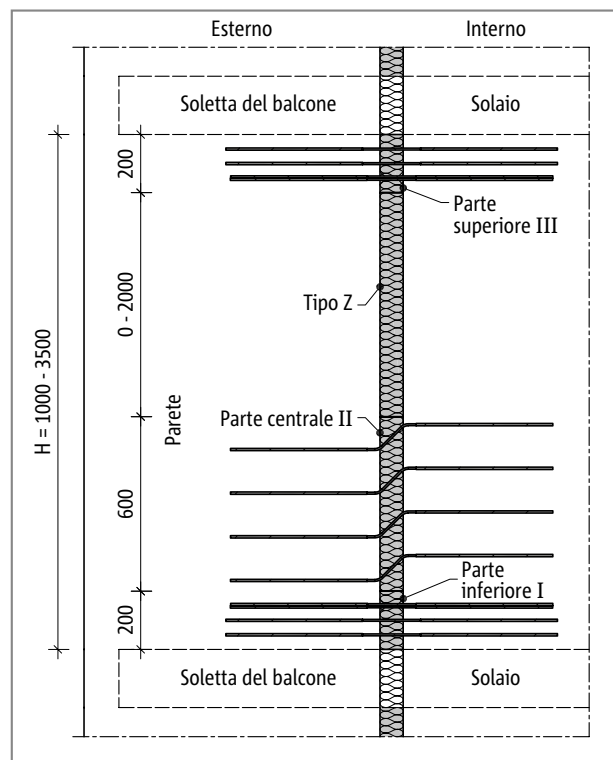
Schöck Isokorb® tipo W, balcone con pareti portanti isolanti
